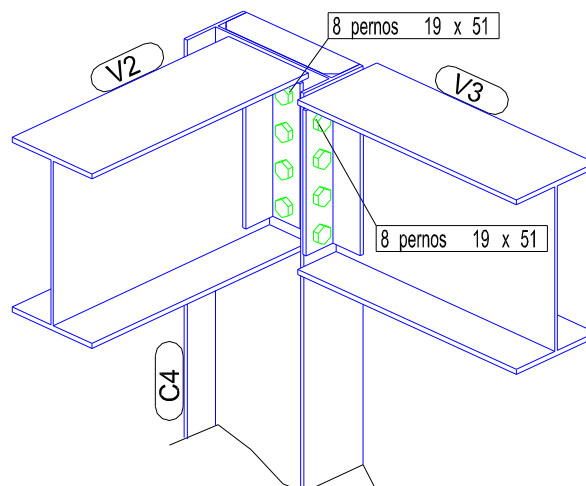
Muestra Conexión Viga IN35-Columna IN30
